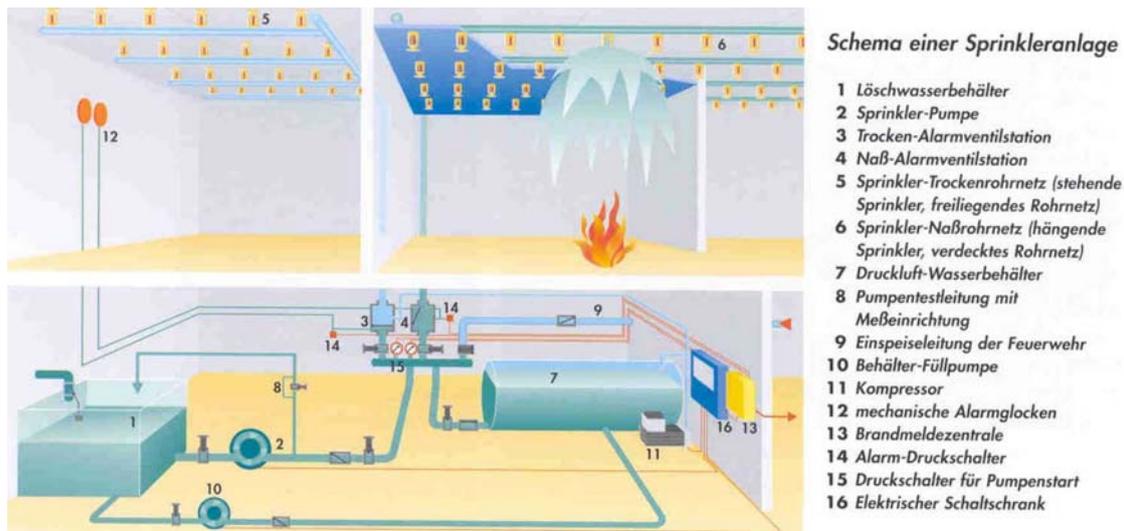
Schema einer Sprinkleranlage [Mayr u. Battran, 2007]
